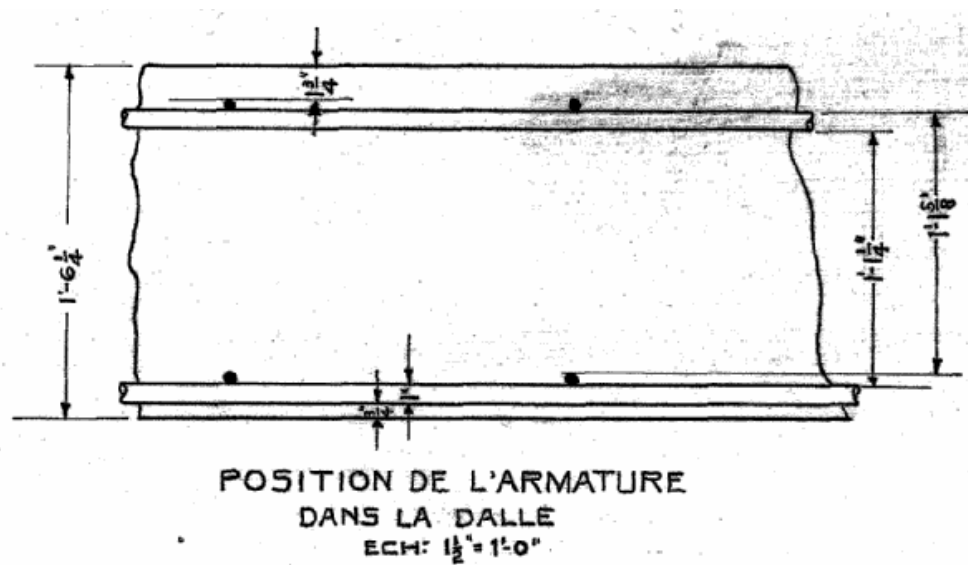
Position des armatures dans la dalle (plans d'origine [5])
